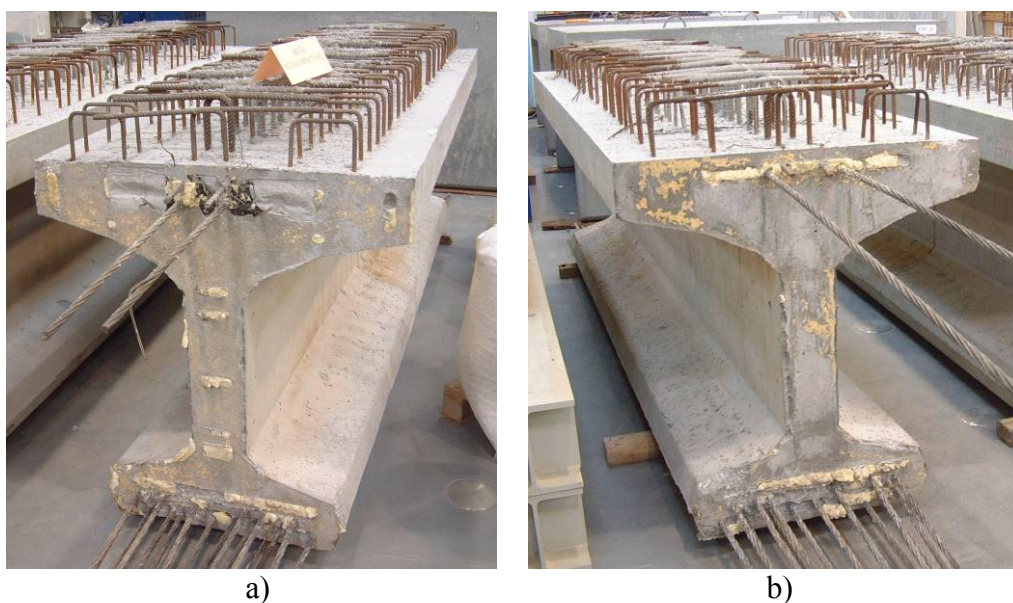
a) Viga I betonada com BAC; b) Viga I betonada com BC
